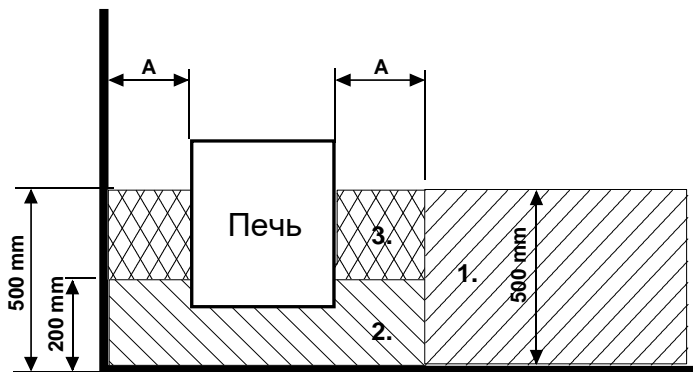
Расположение соединительной коробки для соединительного кабеля в помещении сауны
